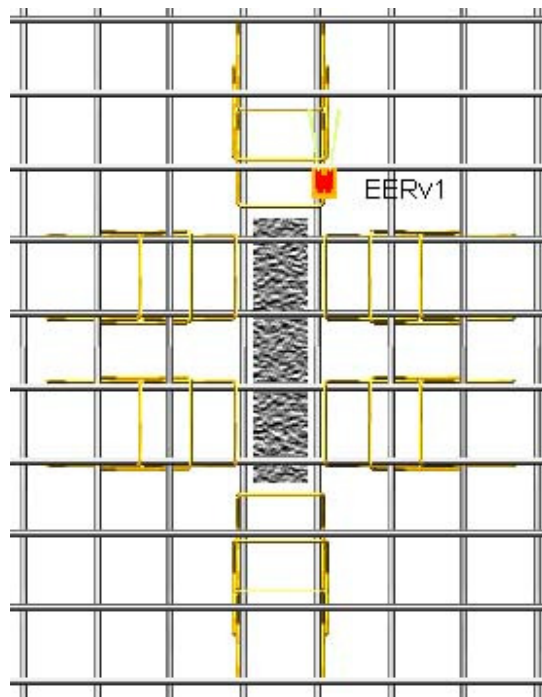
Disposição dos EERs nas armaduras de cisalhamento na laje L8
